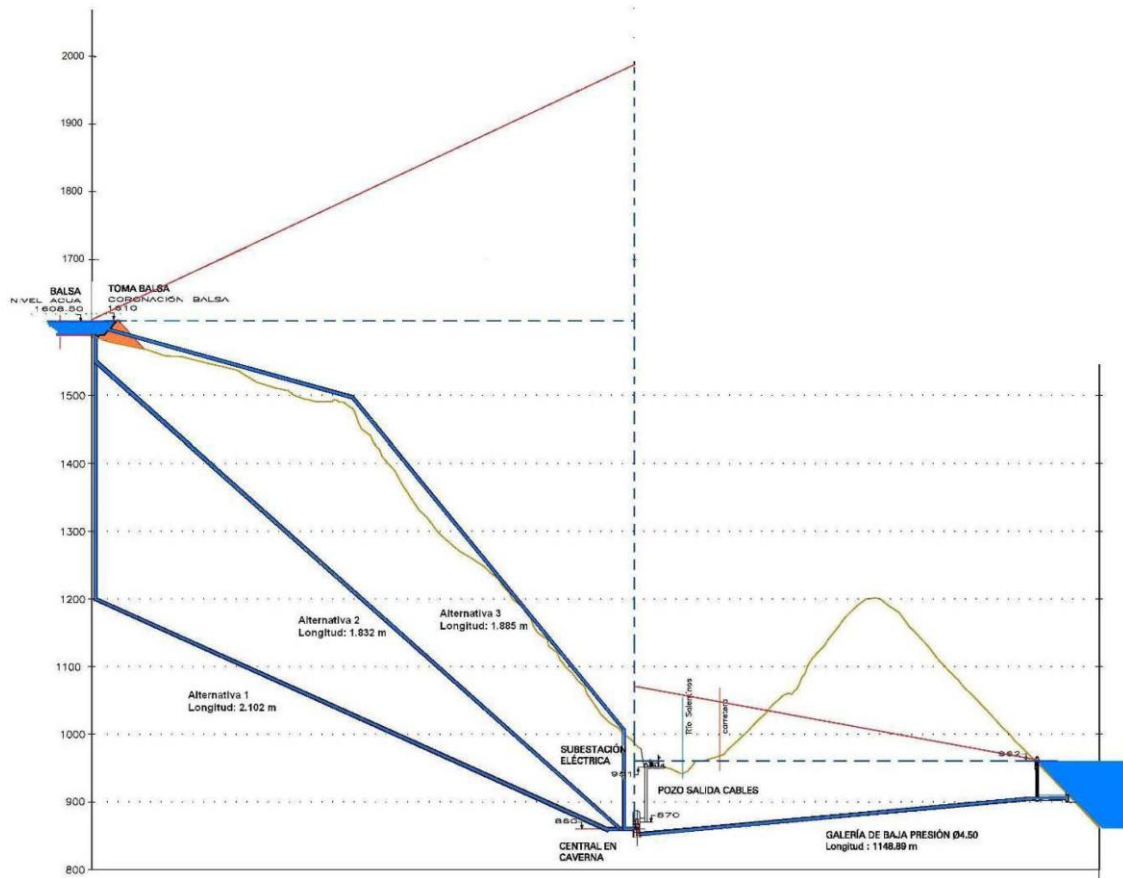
Esquema de alternativas para el trazado en perfil de la tubería
